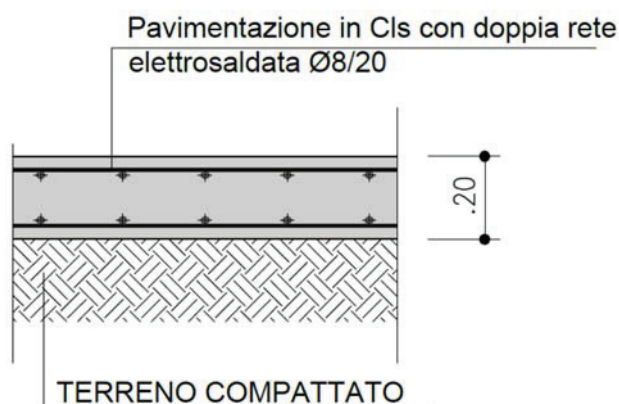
Stralcio del dettaglio tipologico della pavimentazione esistente sull'area.
